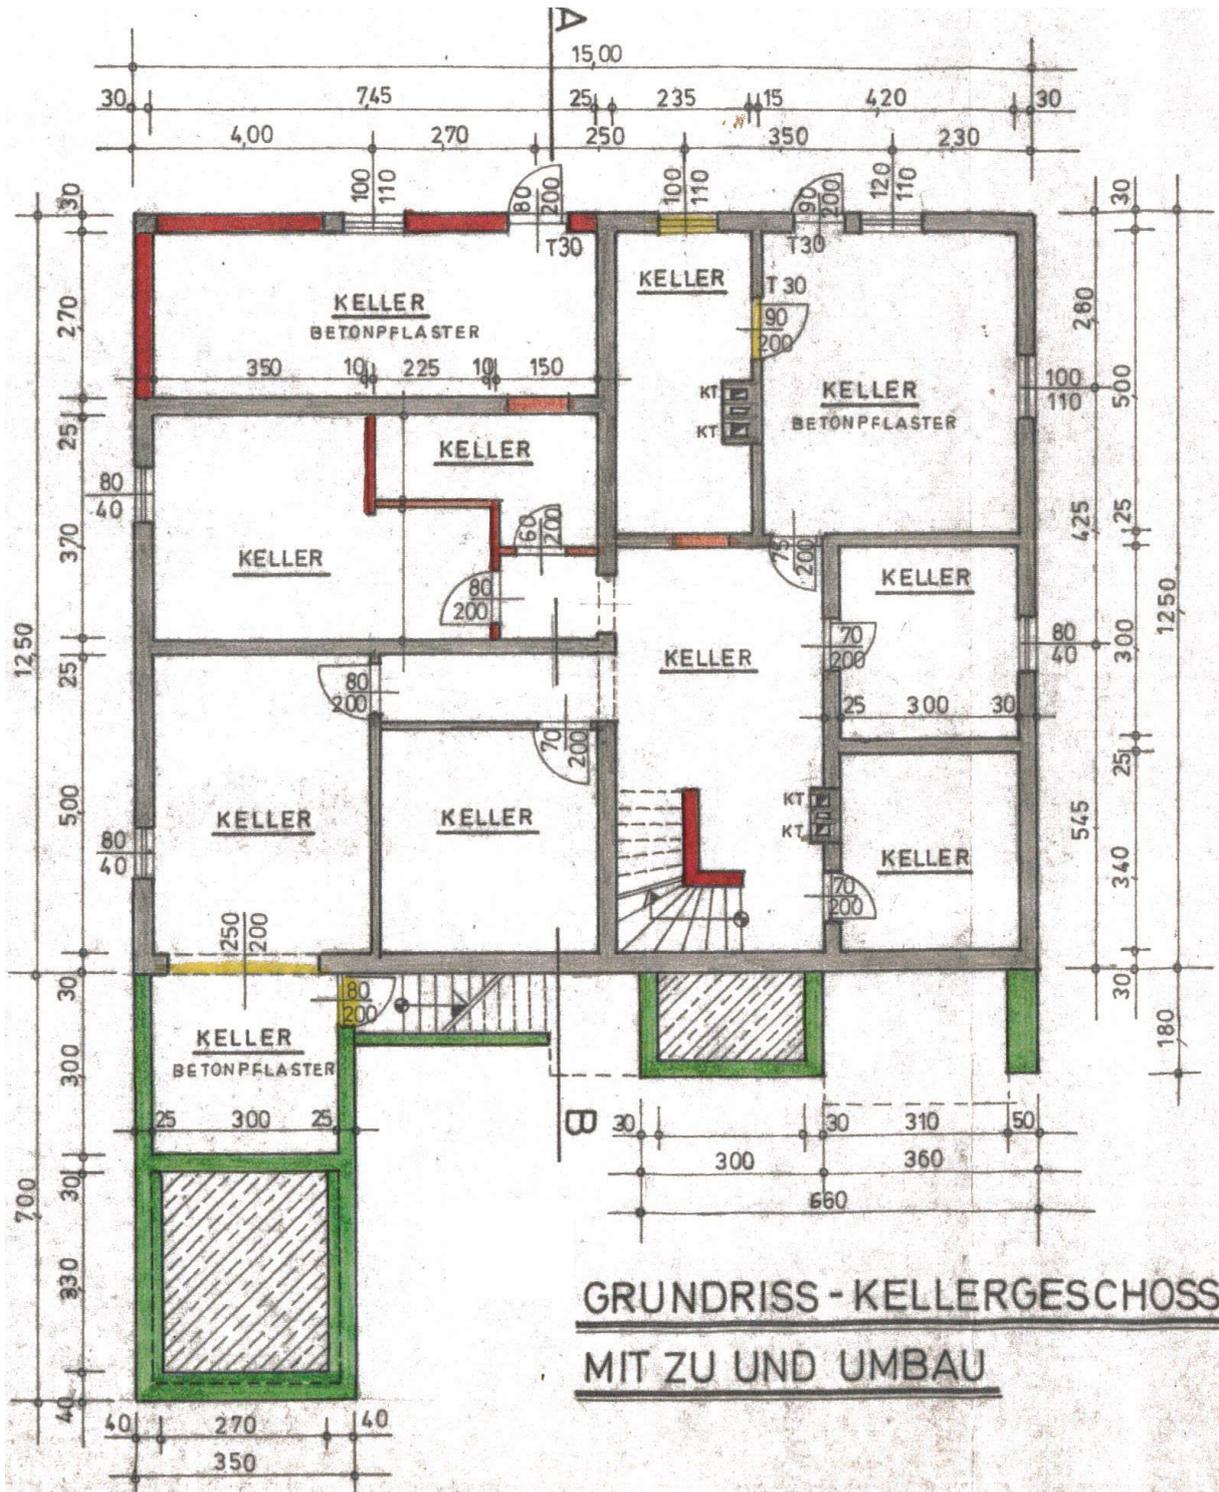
Grundriss KG – Zubauten nicht ausgeführt
